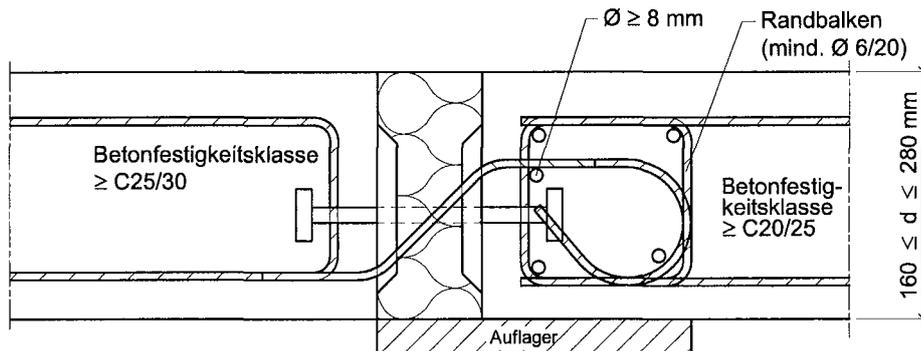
Beispiel Schöck Isokorb Typ Q mit Aufhängebewehrung nach Abschn. 3.2.1
